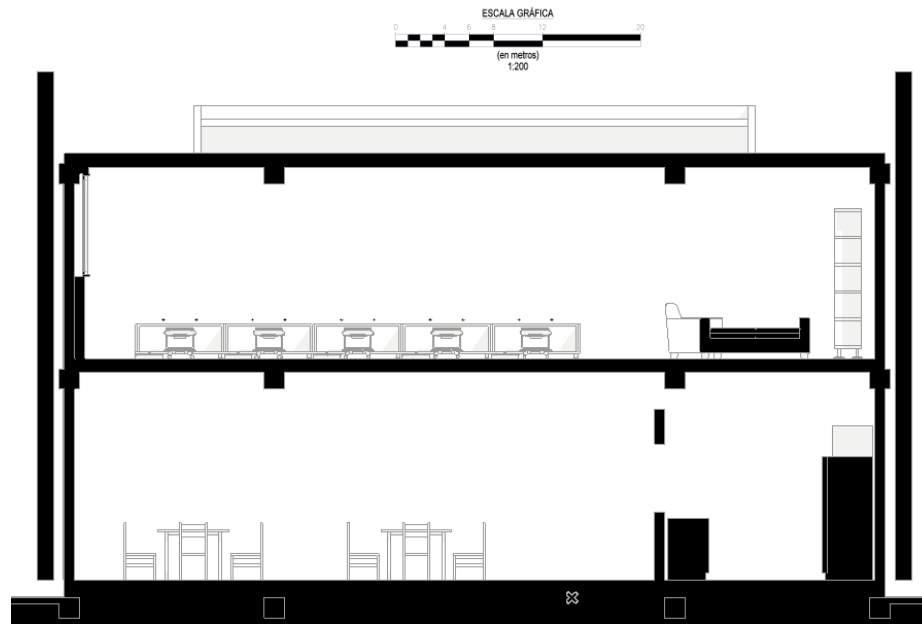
Corte fachada frontal - bloque C / Fuente: Propia
